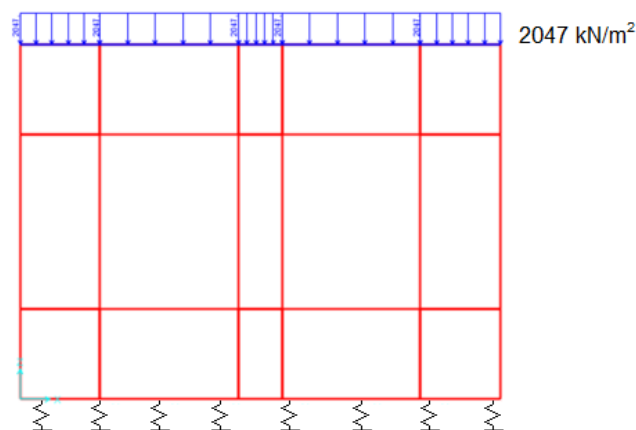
Carregamento a aplicar na estrutura e molas de fundação
